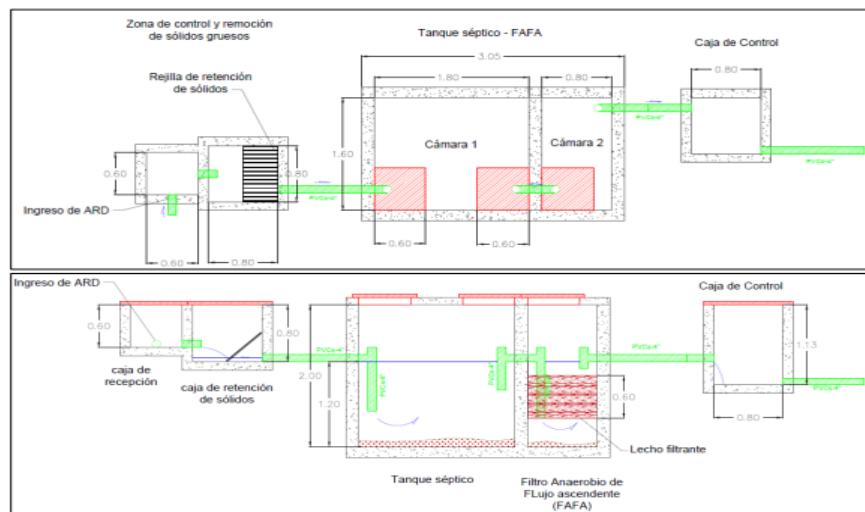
Plano General planta de tratamiento de ARD. Fuente: OCENSA S.A.S., 2021.
